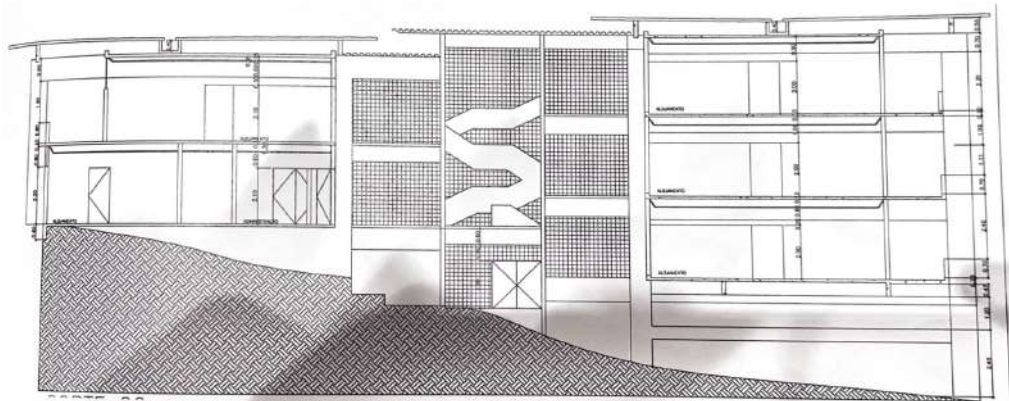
Corte do Hotel, Fonte: BRITTO,2018
